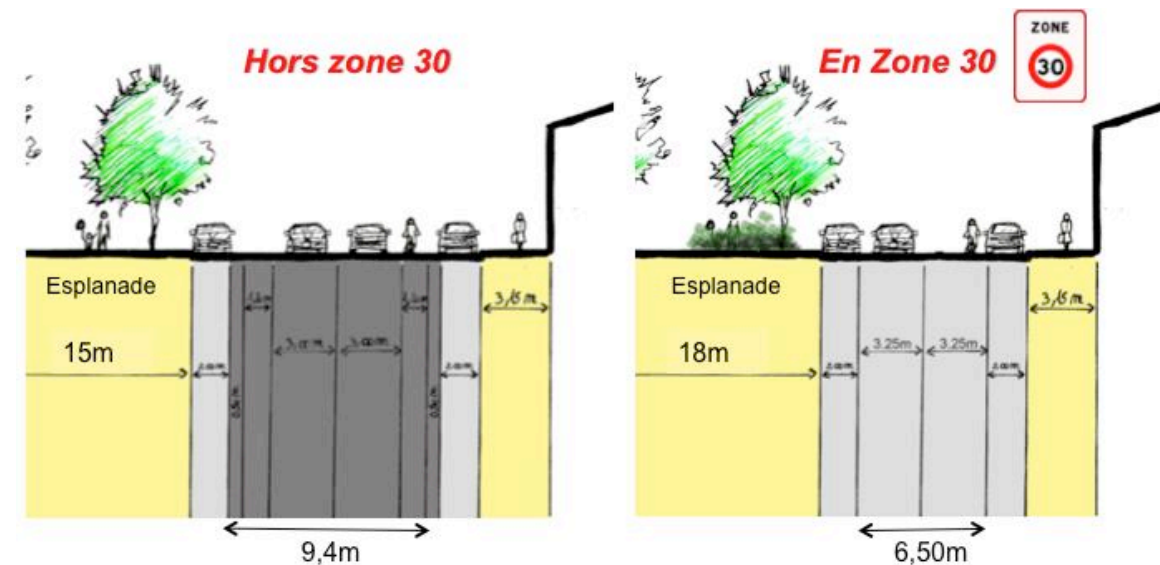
Coupes type de la chaussée de la place Grandclément – Orientations d'aménagement
